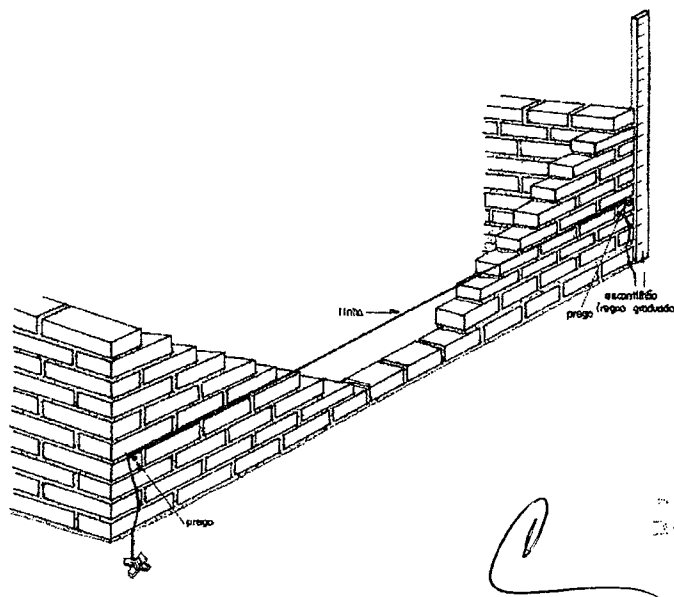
Execução de alvenaria de 1 vez, utilizando tijolos furados.
